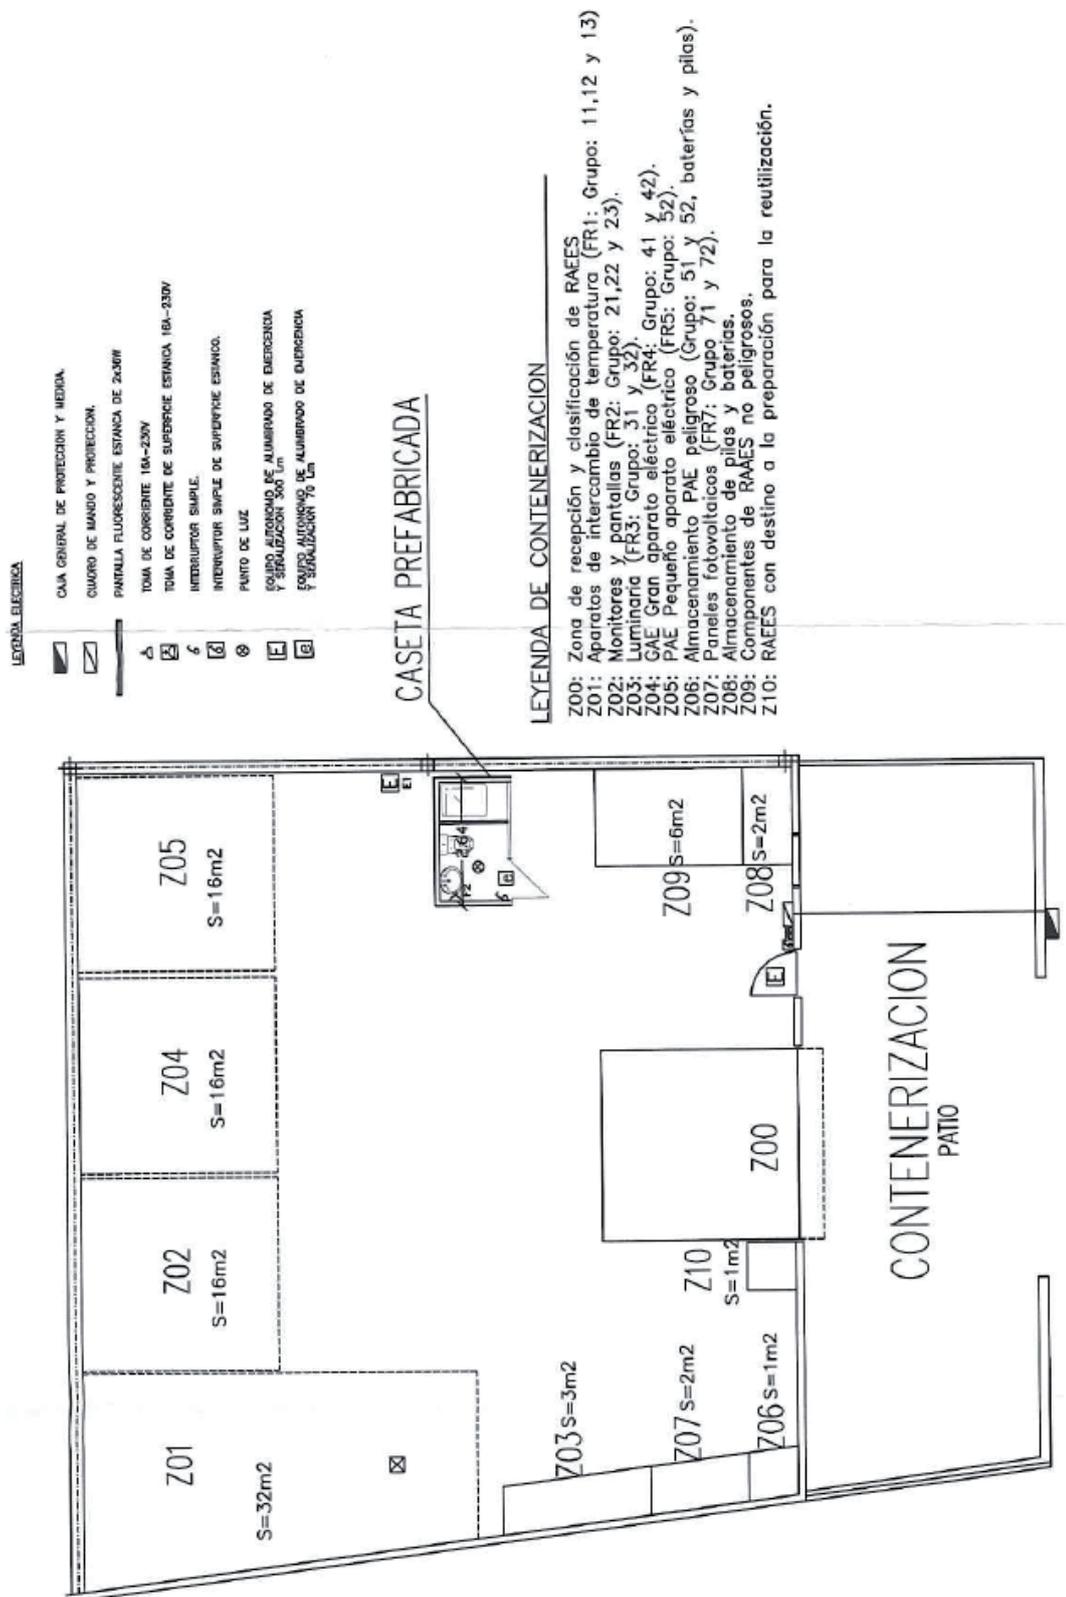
Plano en planta de la nave 9. Distribución de los residuos.
